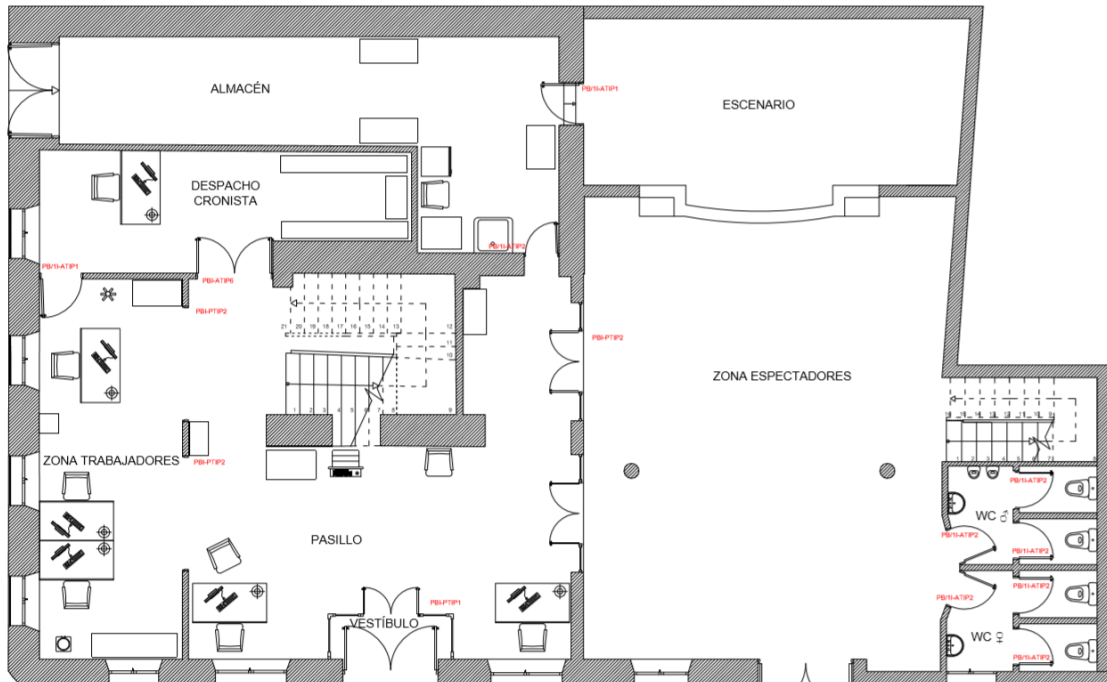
Plano planta baja. Estado actual 2019. Fuente: Elaboración propia, creación 21/06/2019
